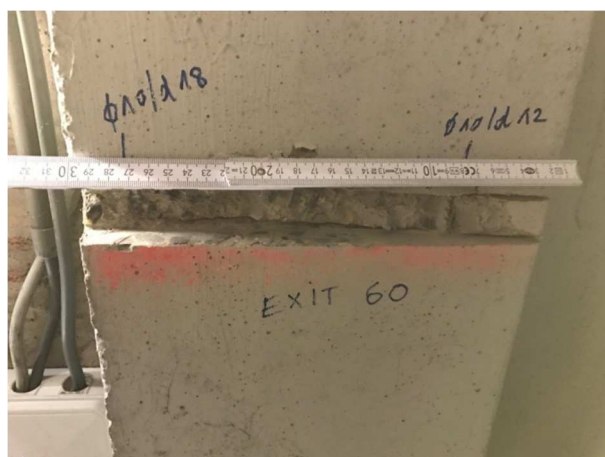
Openstaande voeg tussen balken t.p.v. drukzone (in veronderstelling van een doorlopende balk)
